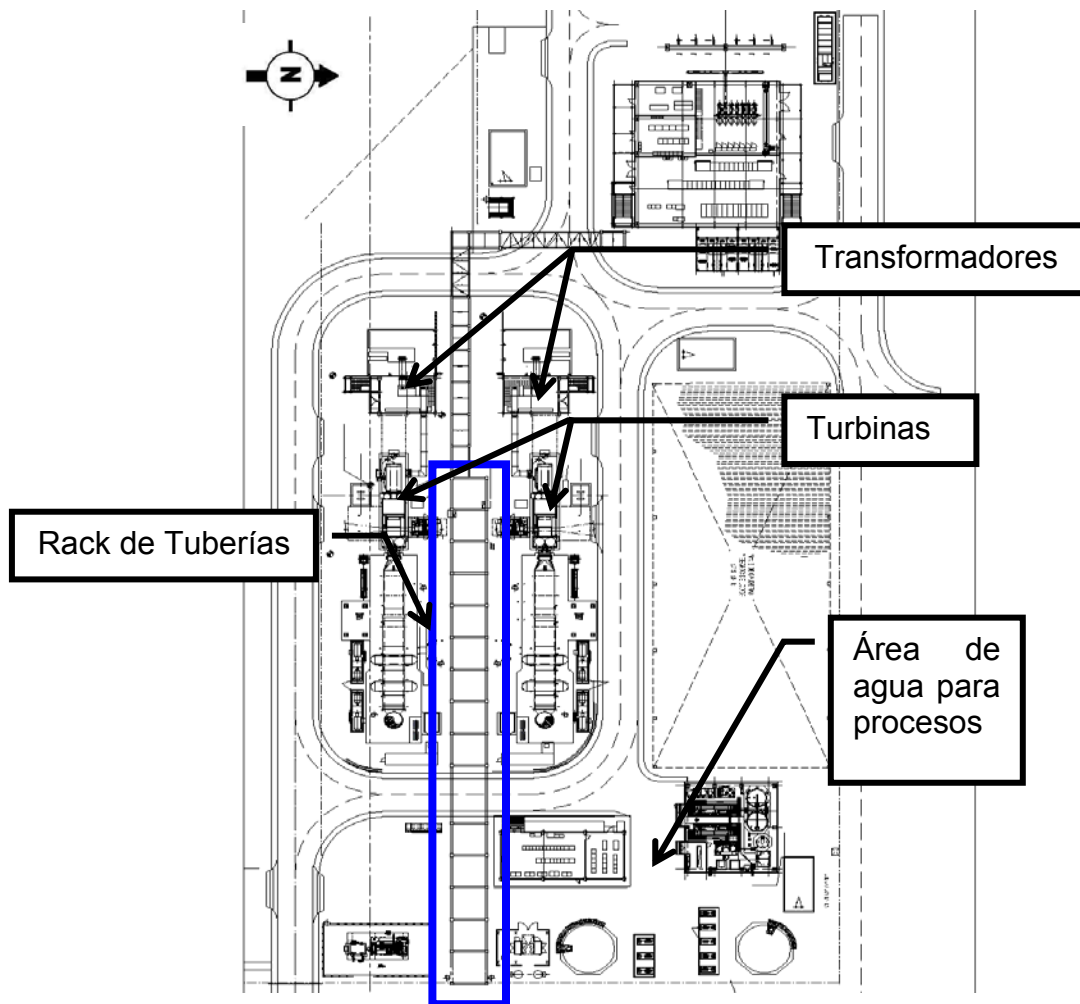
Planta de arreglo general del proyecto, se indica la ubicación del Rack de Tuberías.
